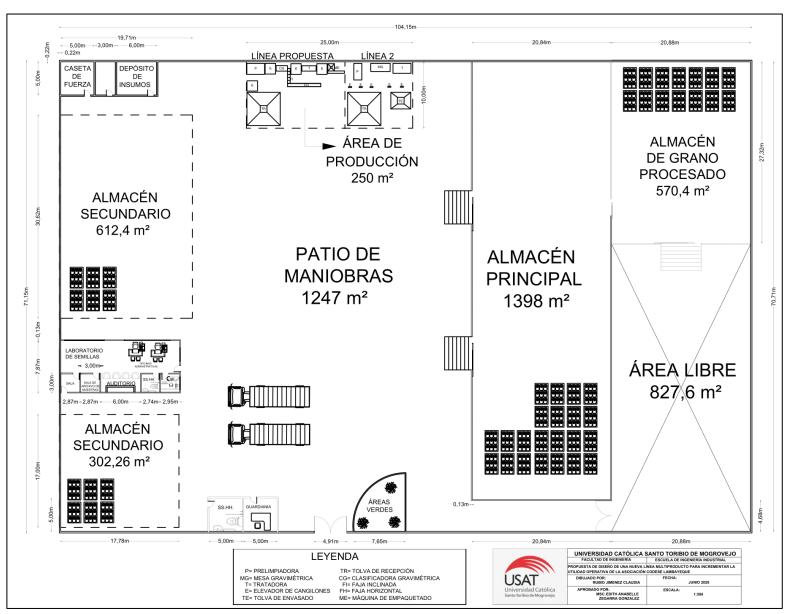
Plano de la planta procesadora con la propuesta Fuente: Elaboración propia
